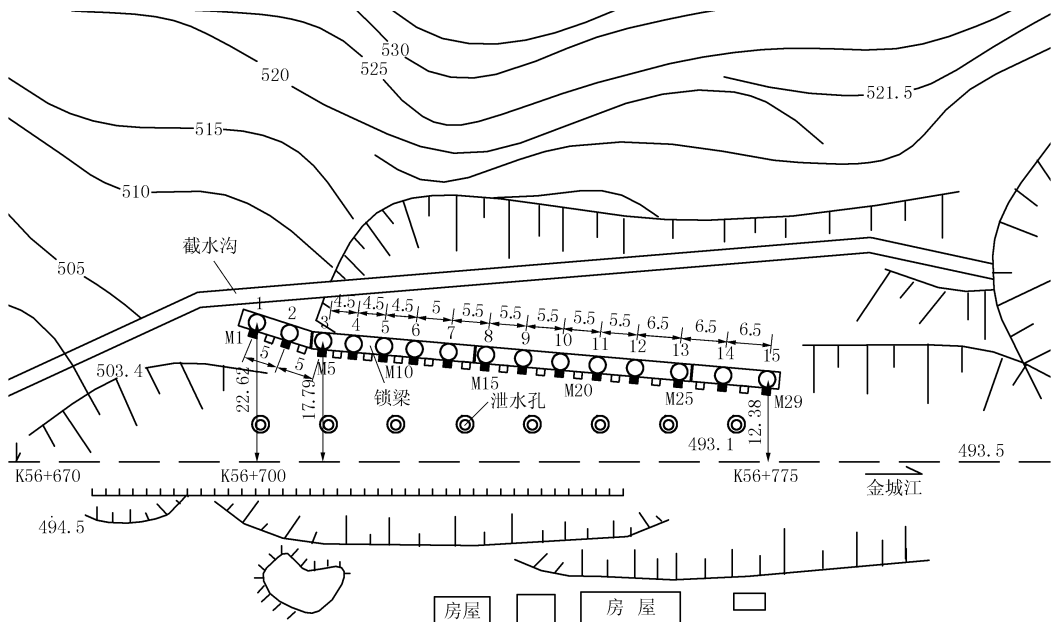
滑坡地貌及加固措施平面示意图(单位:m)
